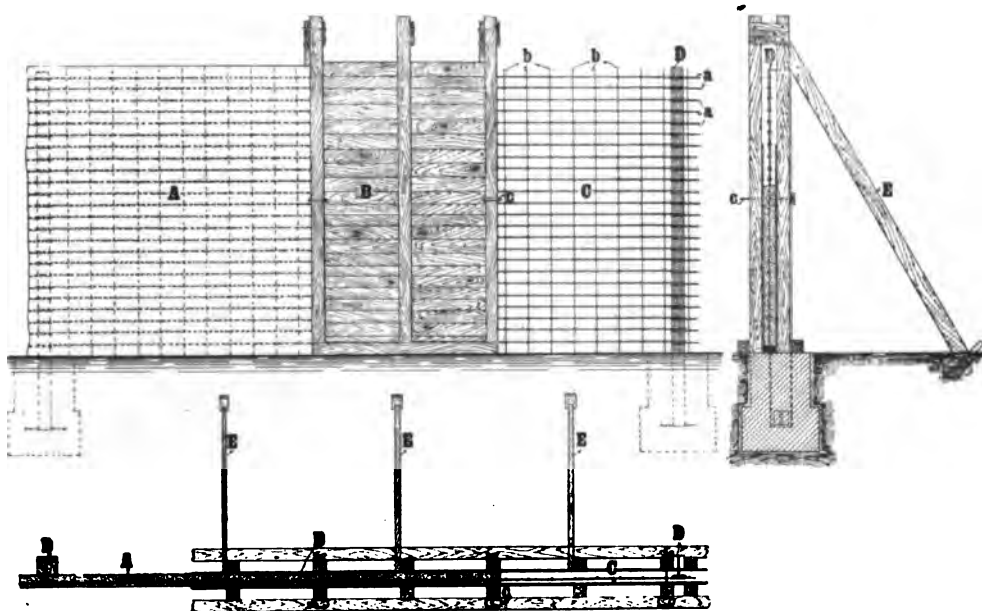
Einfriedigungsmauer aus Eisenbeton.
